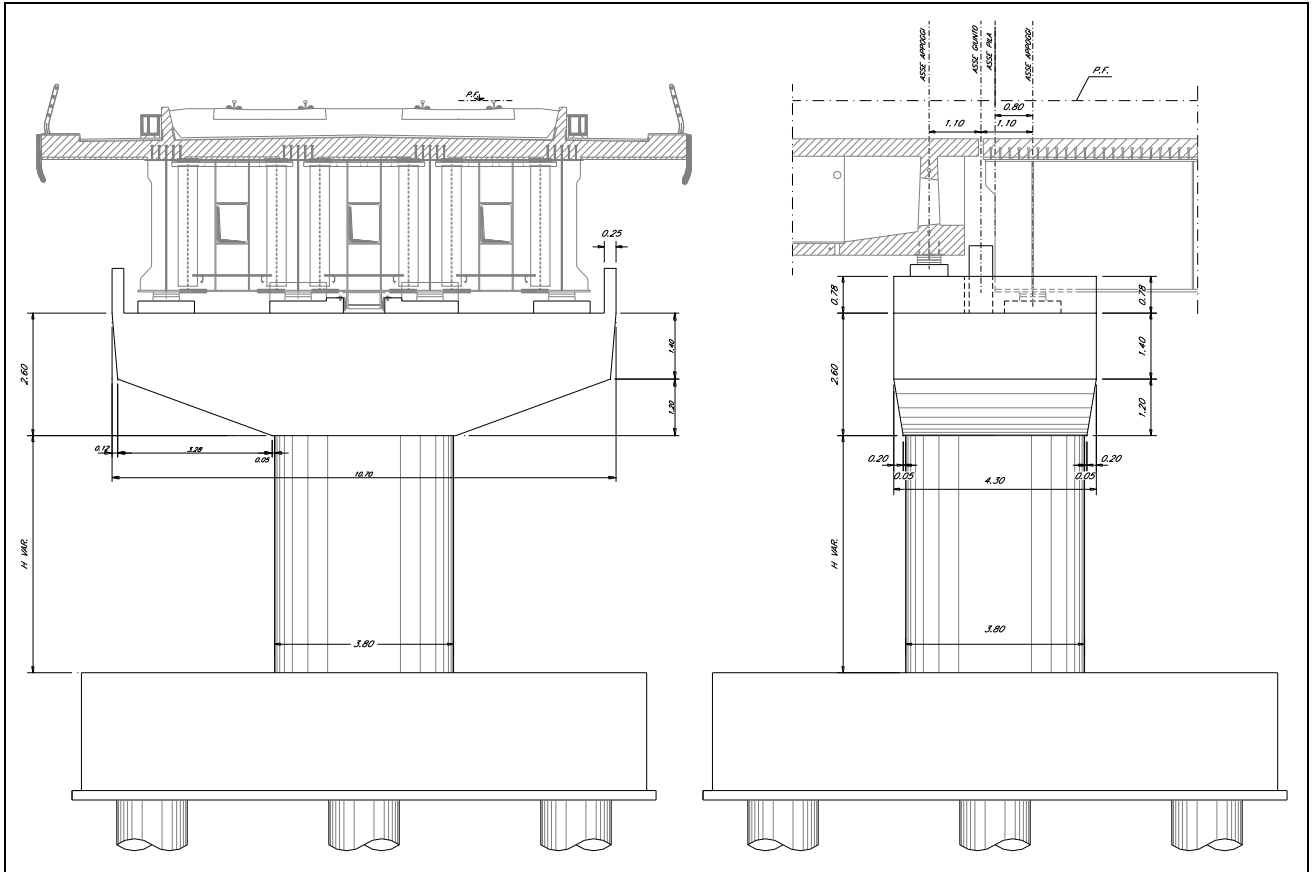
Viste pila con sezione circolare per impalcato L=25.00m
